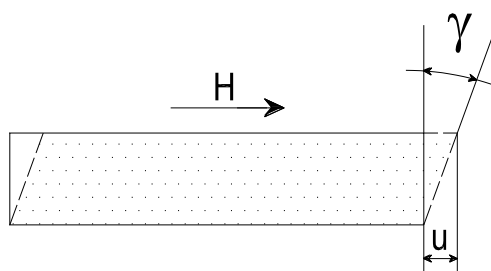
Deformación y distorsión en apoyo de neopreno armado debido a la fuerza horizontal H.
